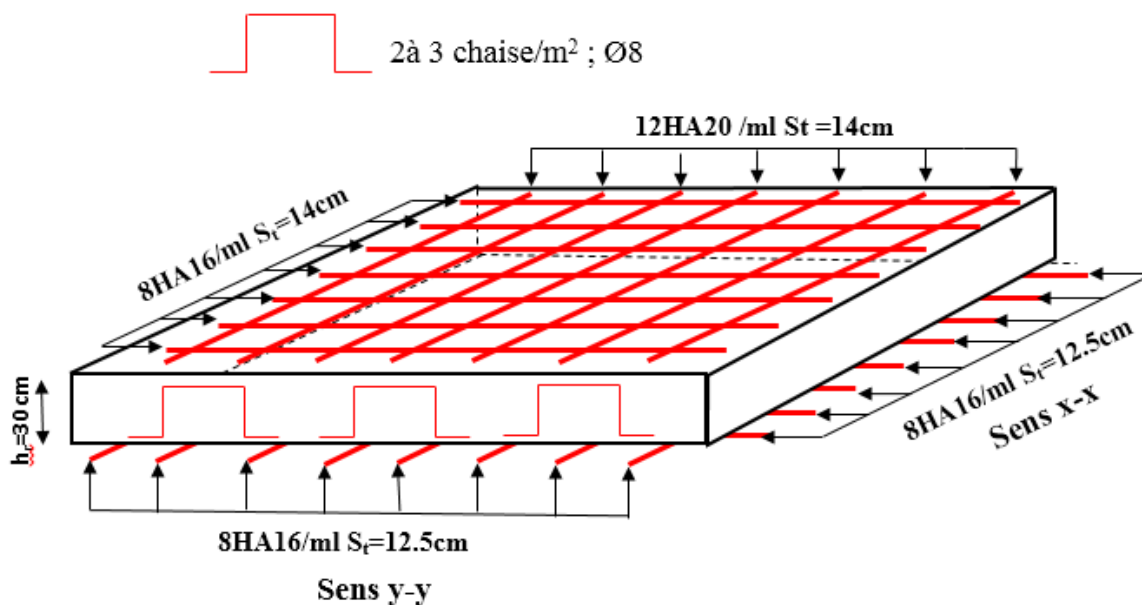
Schéma de ferrailage de la dalle du radier
